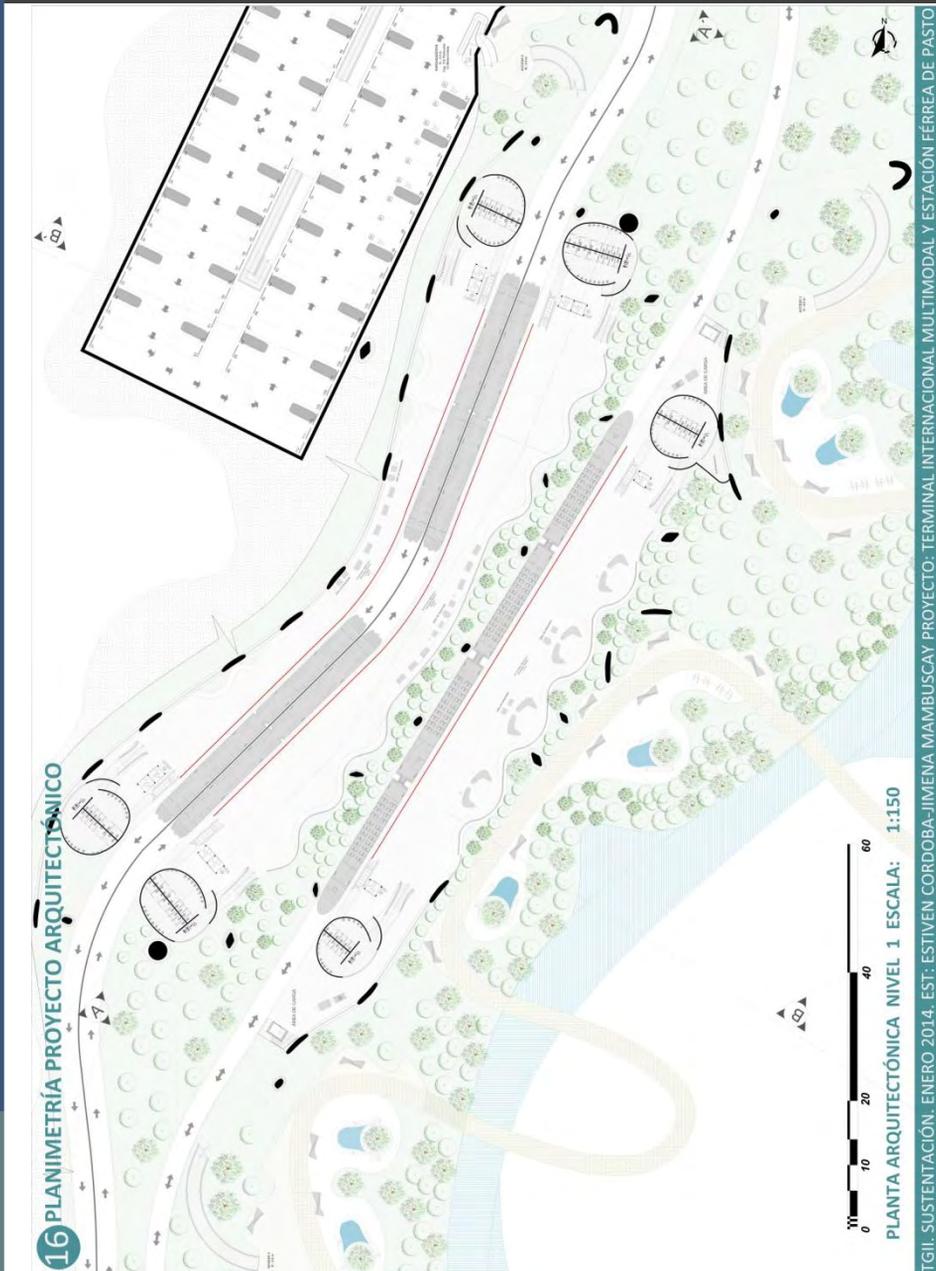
Planta de Primer Nivel Fuente: Esta investigación
